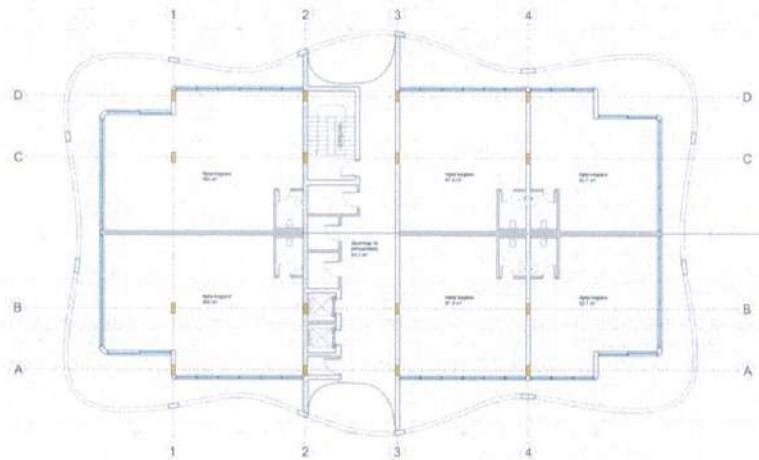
Planimetri kati përdhe, kuota (+0.00)
